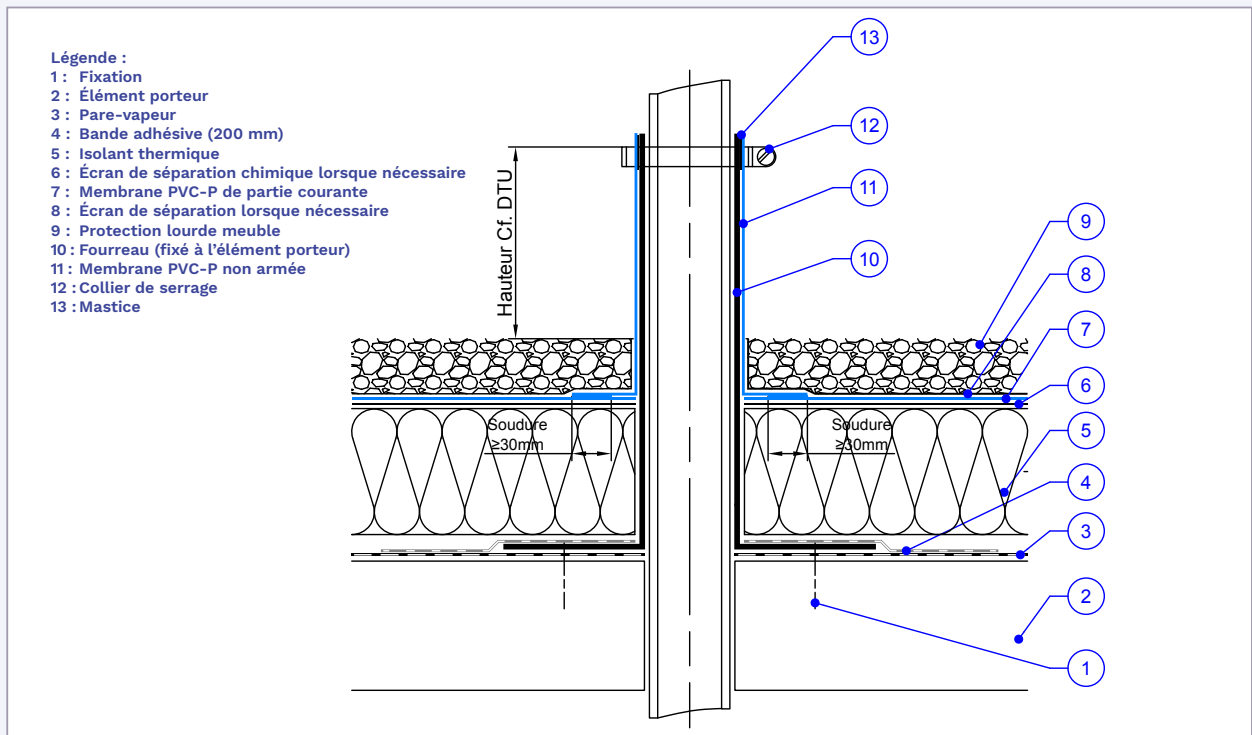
Raccordement sur tuyau métallique avec un accessoire préfabriqué
